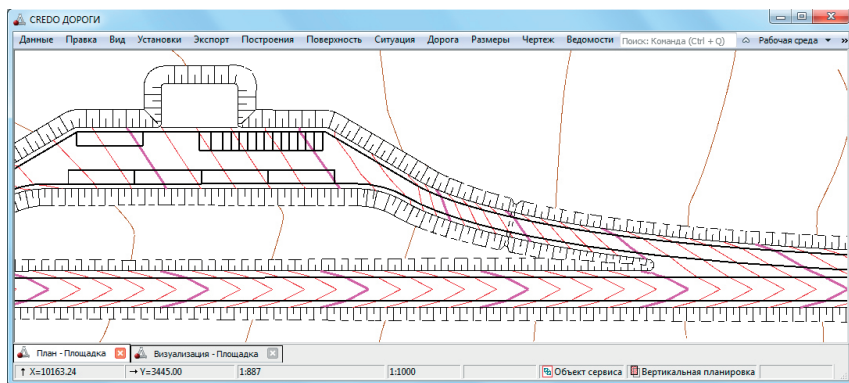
Проект вертикальной планировки площадки для размещения ОДС и подъездов к ней
